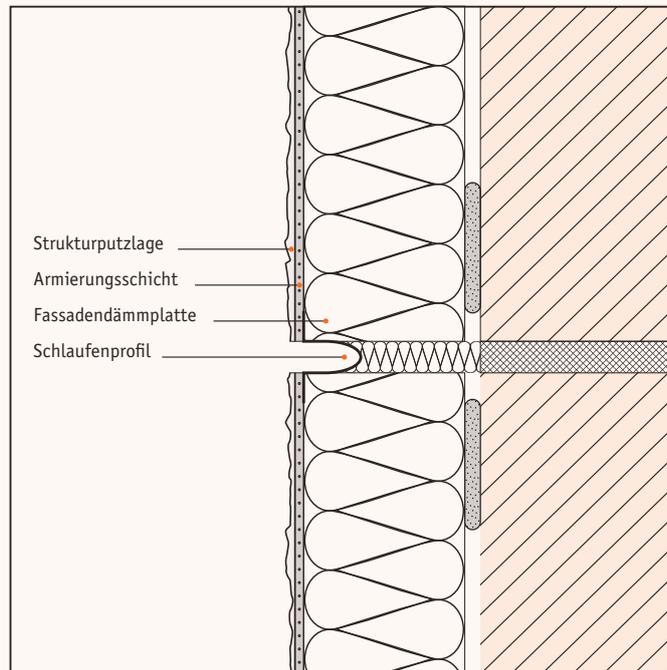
Vertikale Bewegungsfugen mit Schlaufenprofil (Horizontalschnitt)
